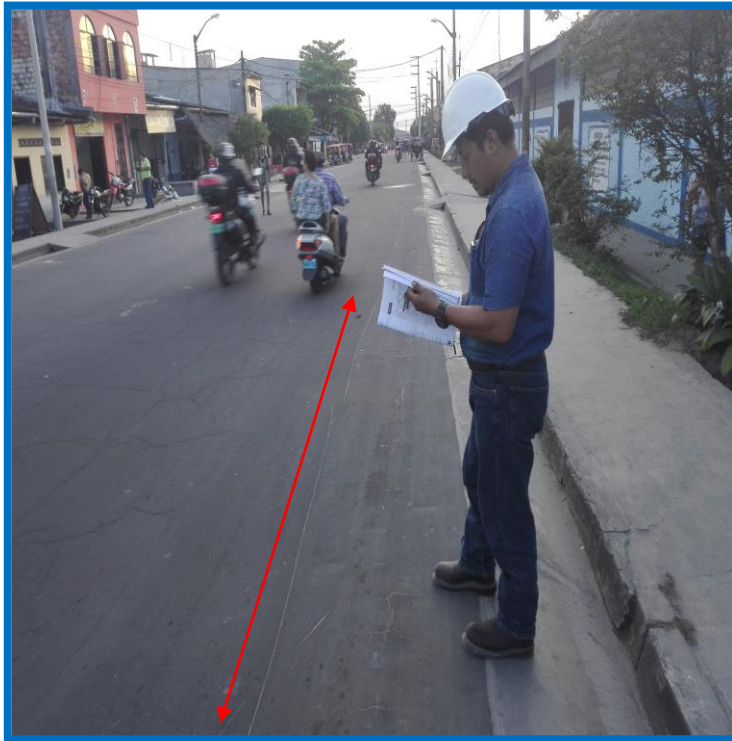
Vista panorámica de la patología 10 (grieta long.) en la UM2 de la Calle Túpac Amaru
